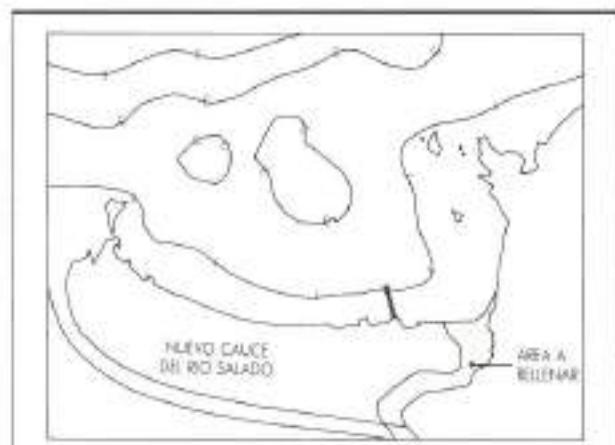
Primera variante de reencauzamiento del río Salado.
